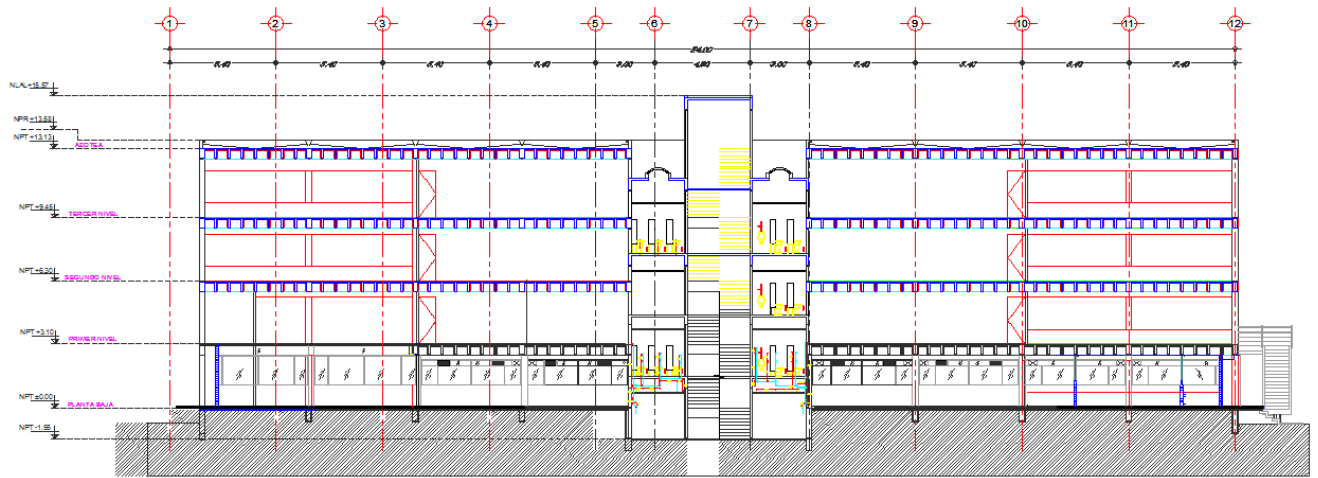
Plano de la fachada del edificio 5 elaborado en Auto CAD.
